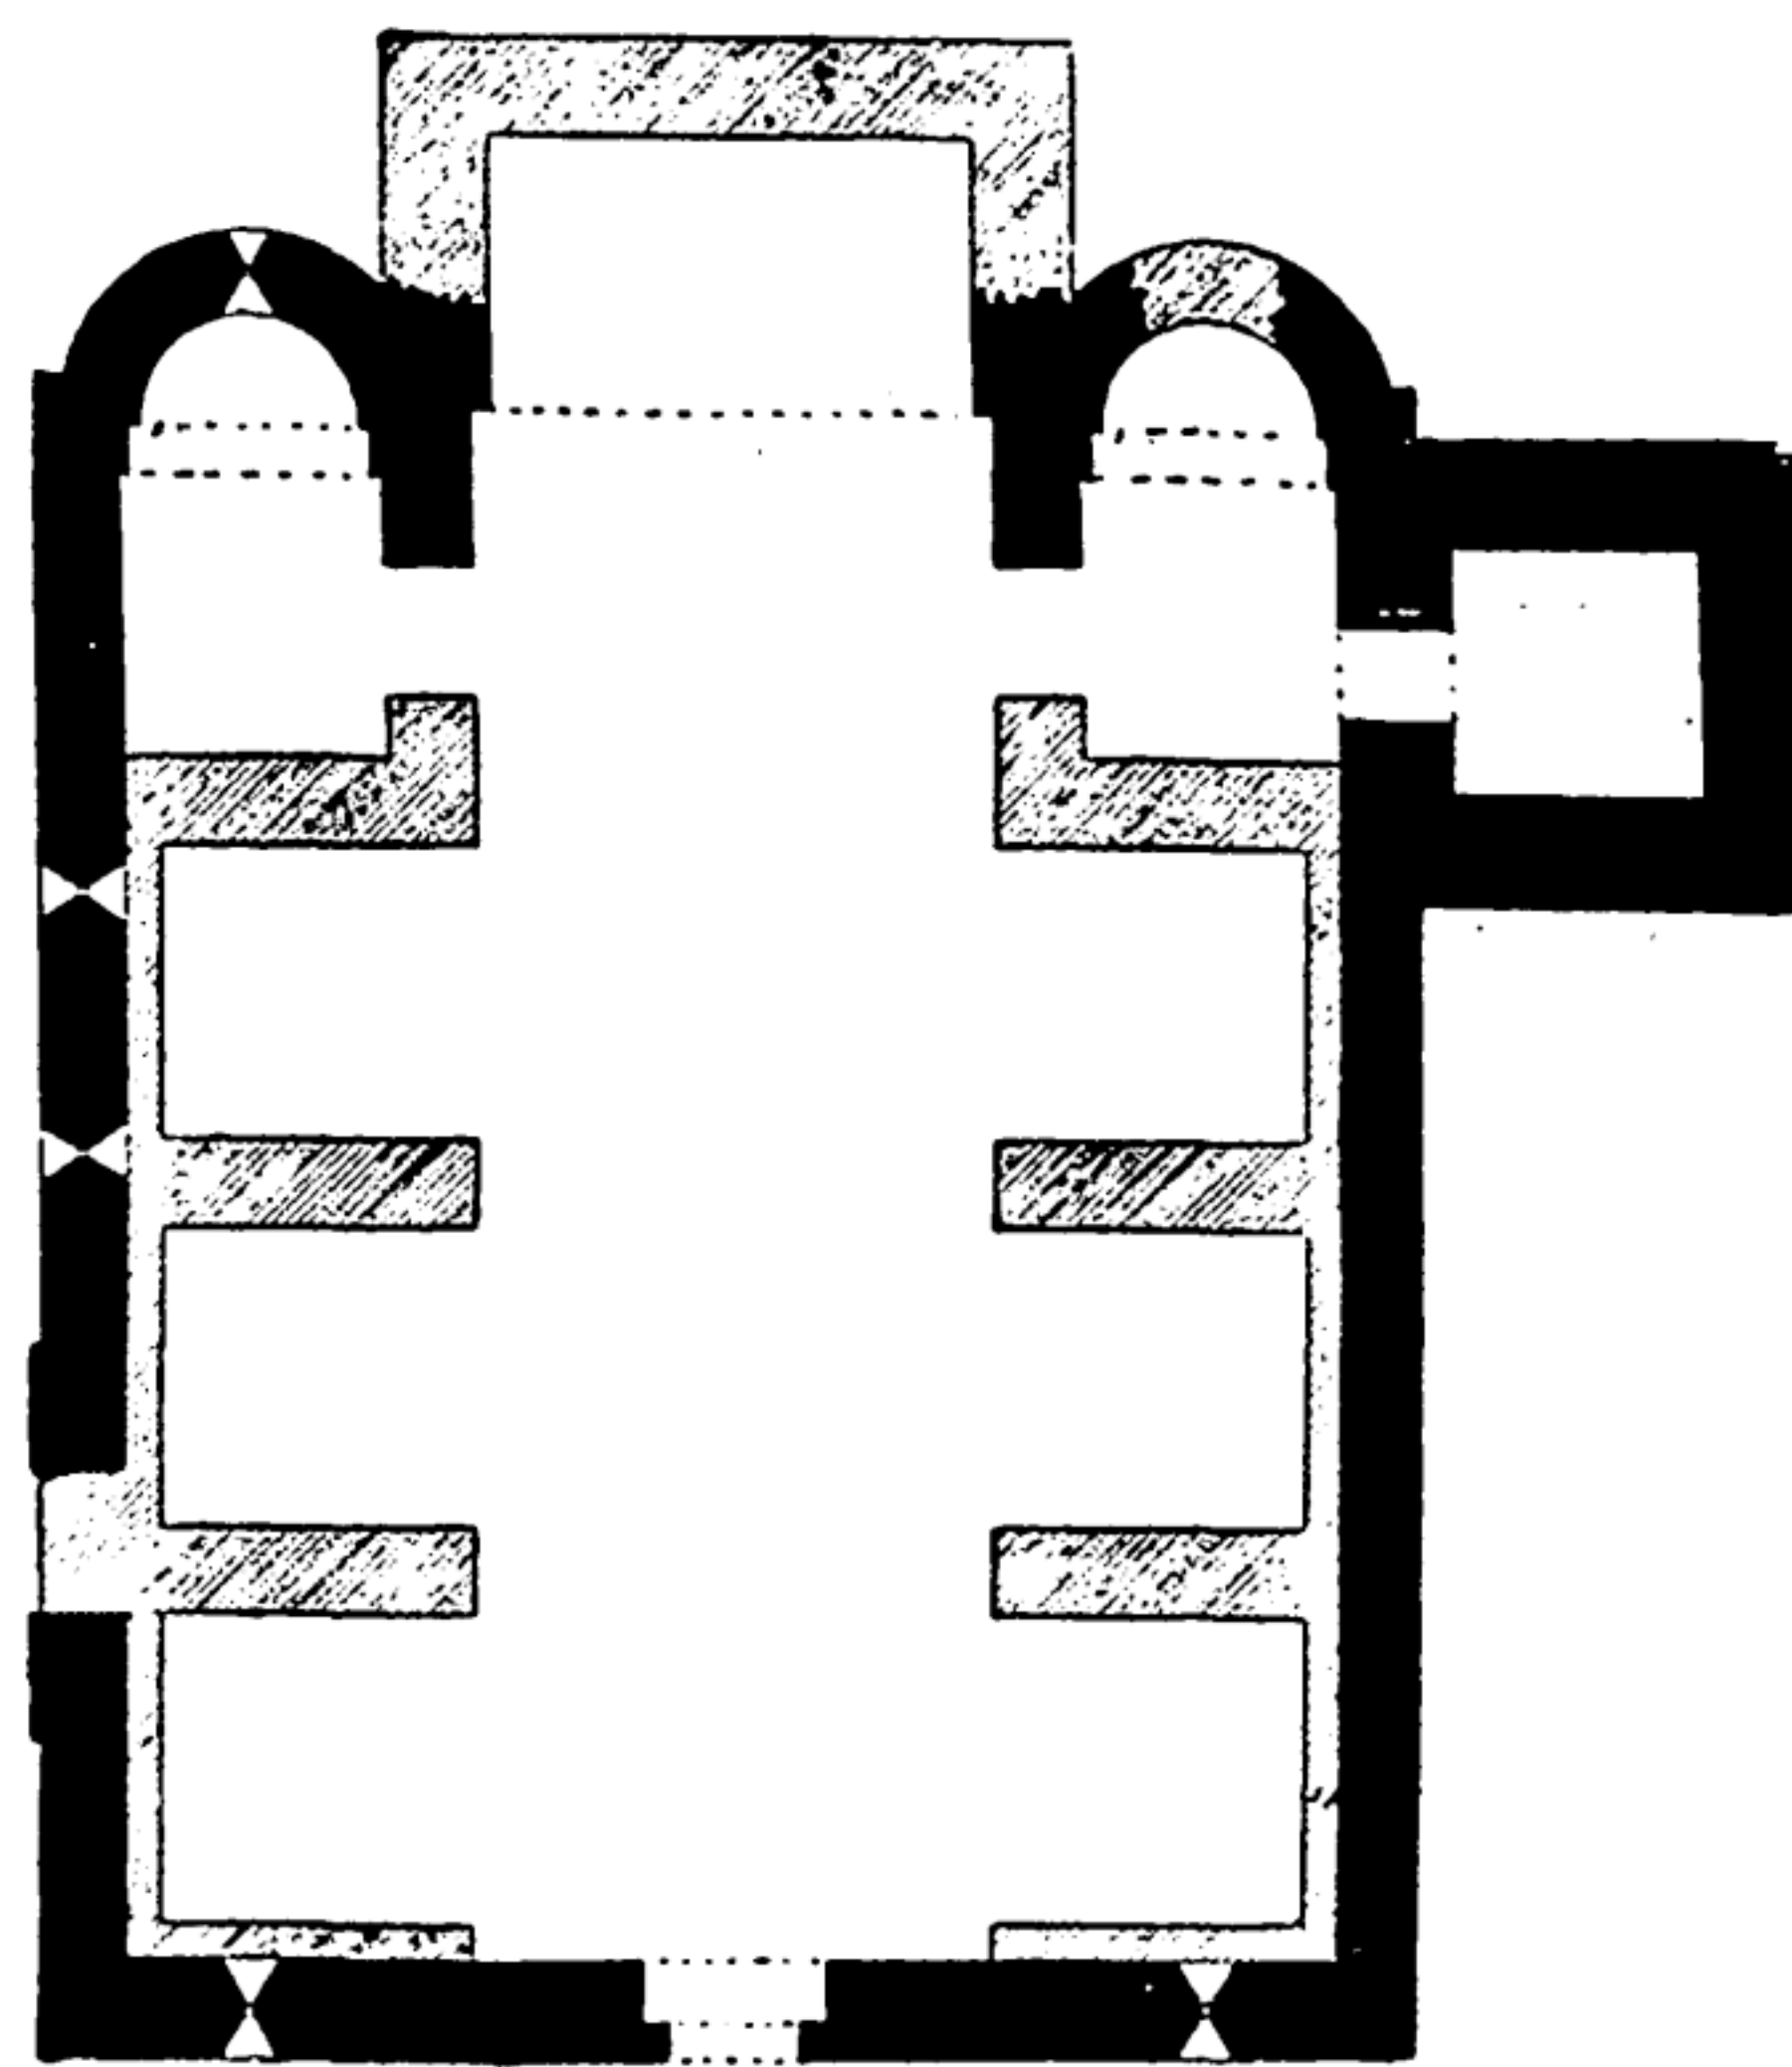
Planta de l'Iglesia de Santa Maria de Bohí.
